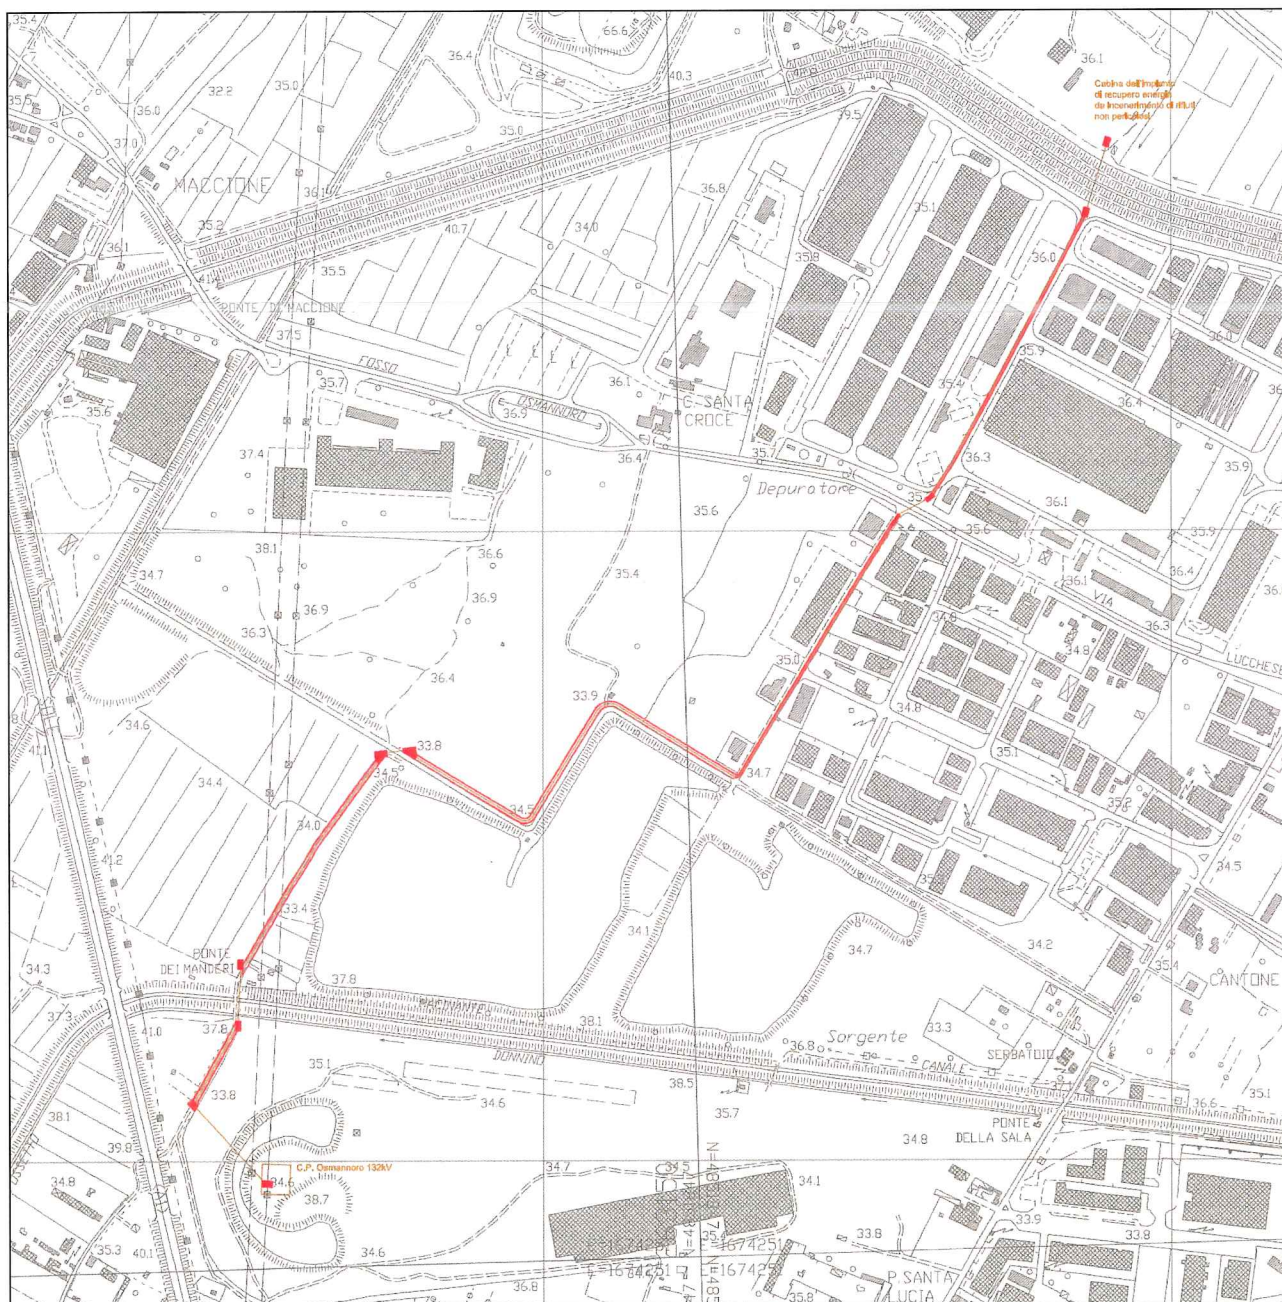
Tracciato di progetto della linea elettrica interrata di connessione alla rete di distribuzione ENEL
